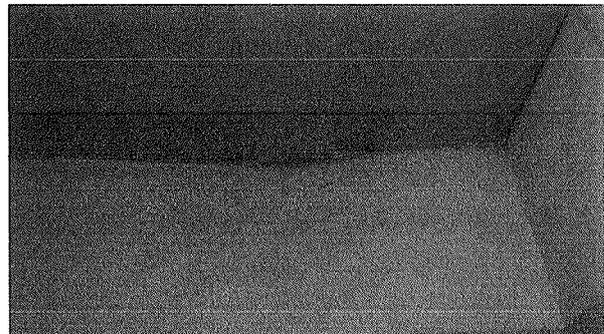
forro em má estado de conservação, sala de cima, problema decorrente na edificação
